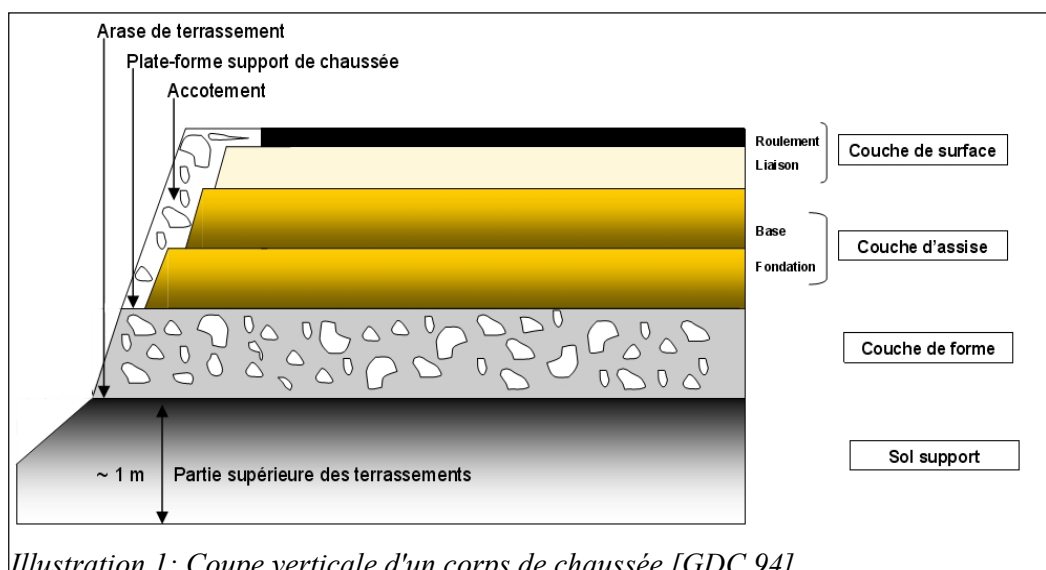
Coupe verticale d'un corps de chaussée [GDC 94].
